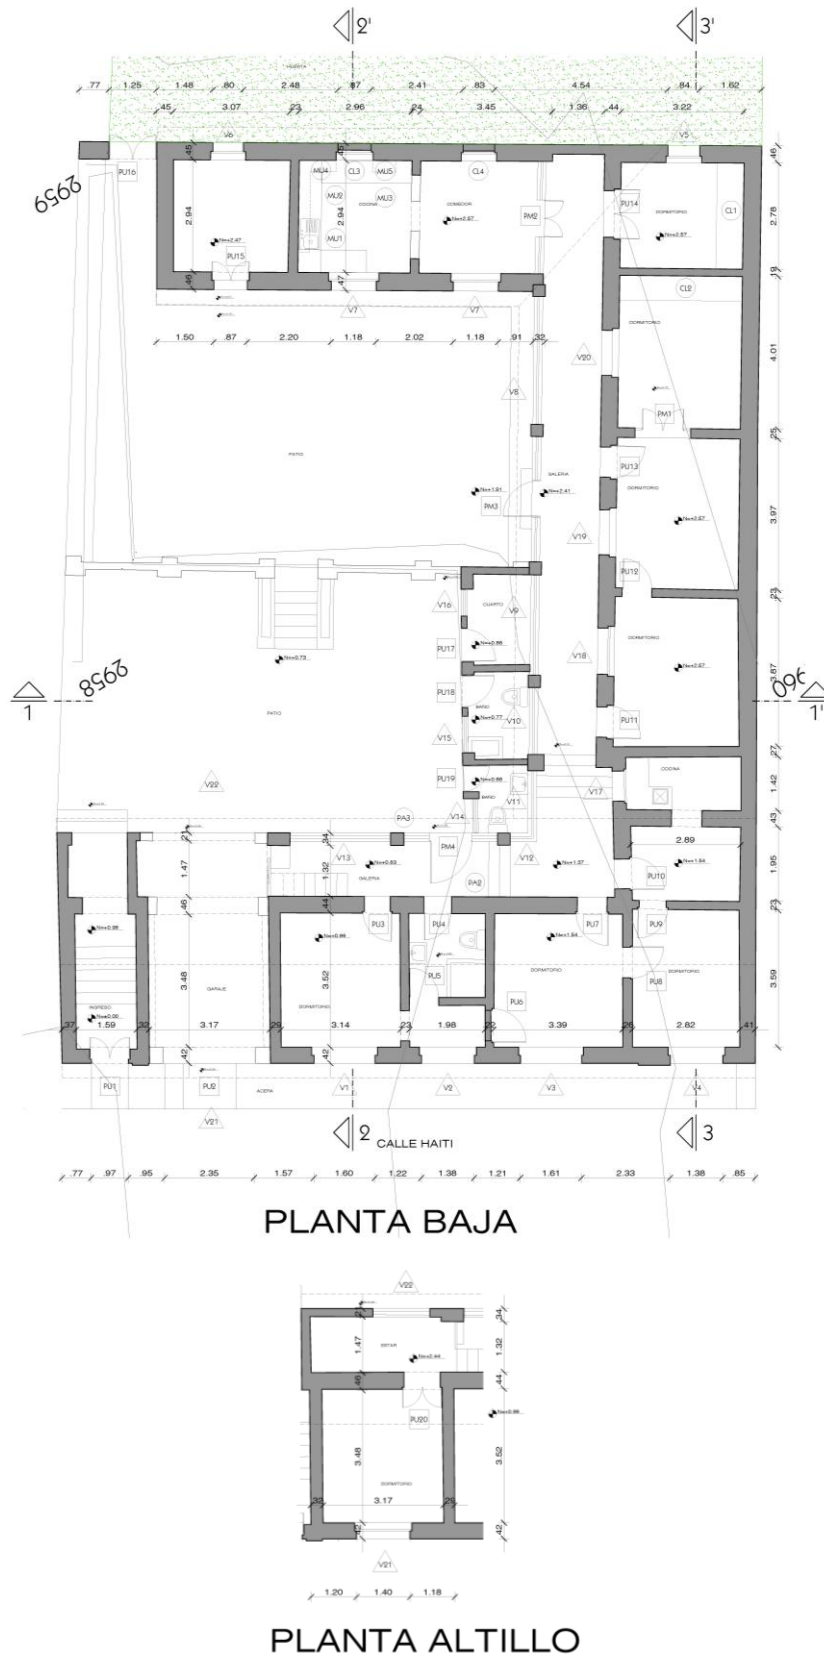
Plantas inmueble existente. Elaboradas por (Cabezas I., 2017)
